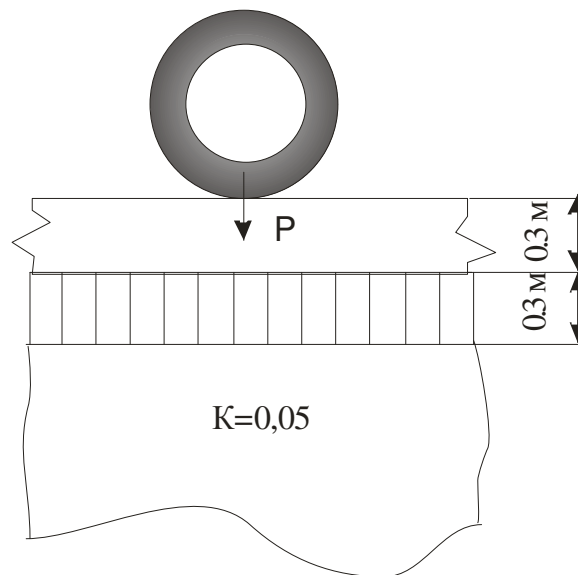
Расчетная схема нагружения геооболочки ГеоФРАМ сосредоточенной нагрузкой.
